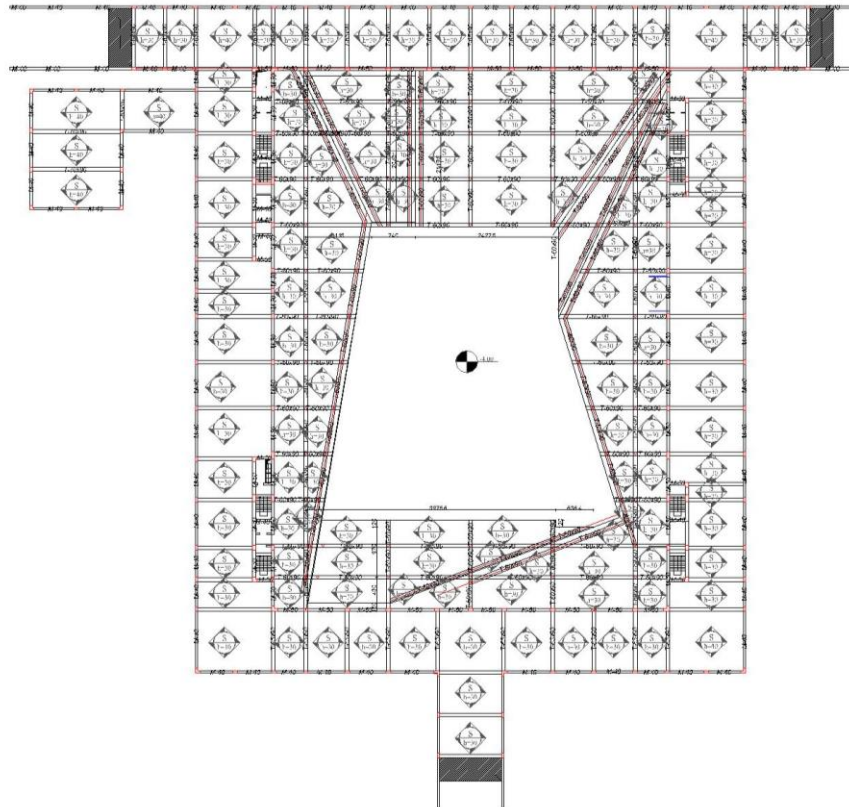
Plani i kolonave dhe strukturave ne kuoten +0.00 m
